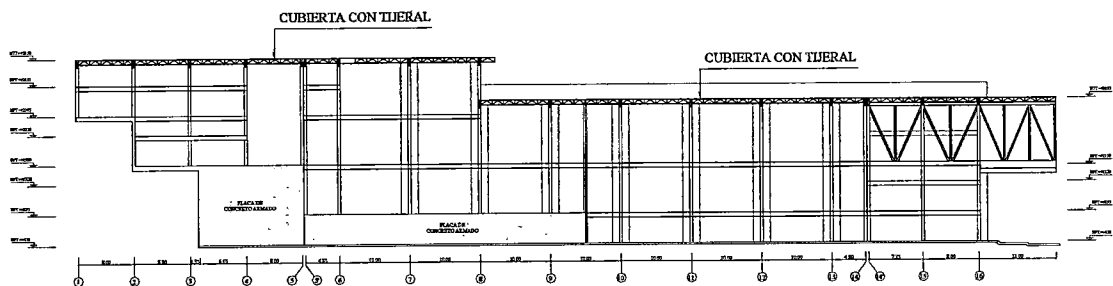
Proyecto [Bloque 1: Estructura de Fachada]
